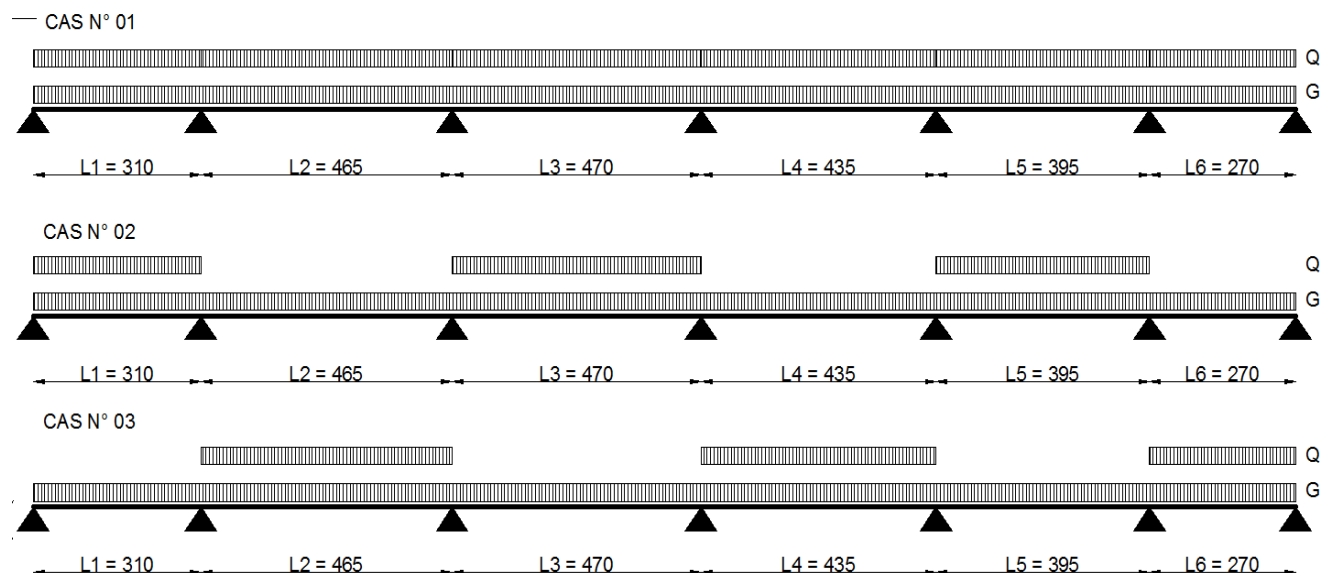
Schéma statique des 3 cas de la poutrelle type 2a
